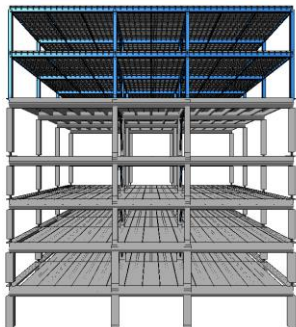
Схема споруди із варіантом надбудови у сталевому каркасі із балочним перекриттям та покриттям
